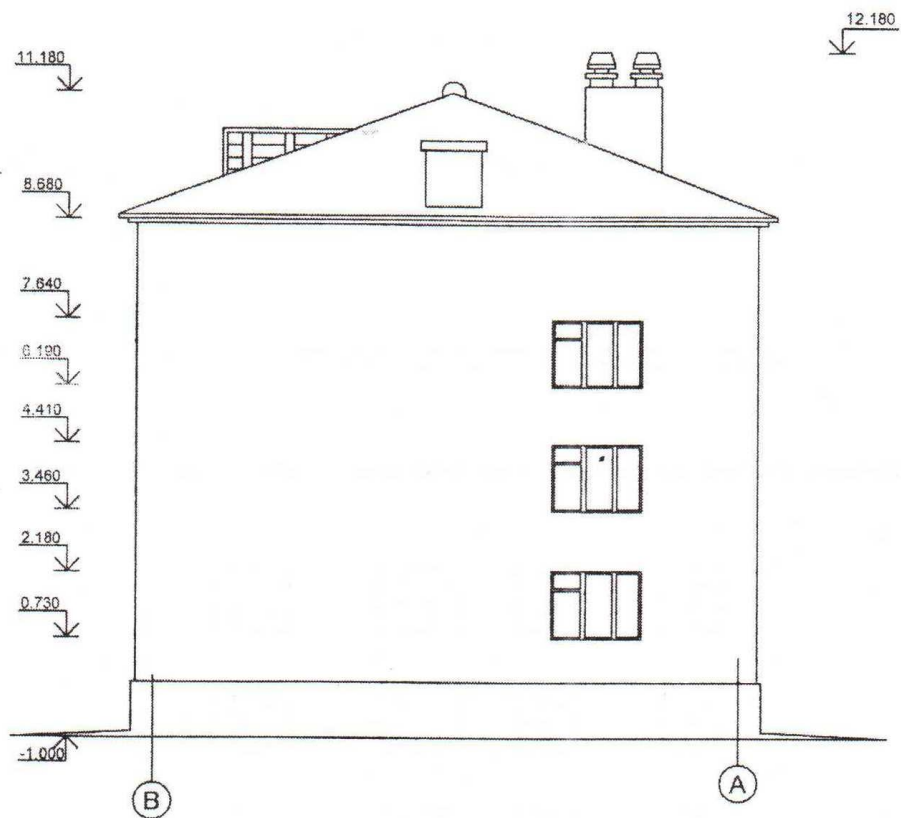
Фасад будівлі (боковий) М 1:100
